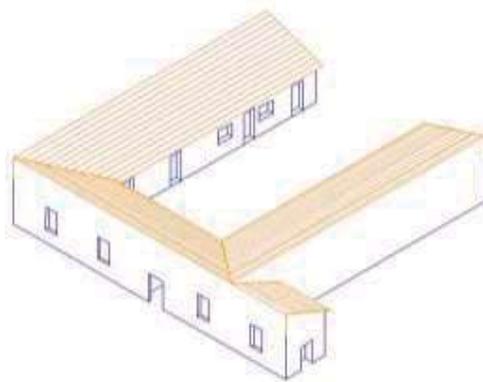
Configuración primaria de la Casa Cural, con un posible patio o colindancia con casa en mal estado en la fachada oriente. Elaboración de las autoras, junio 2010.
